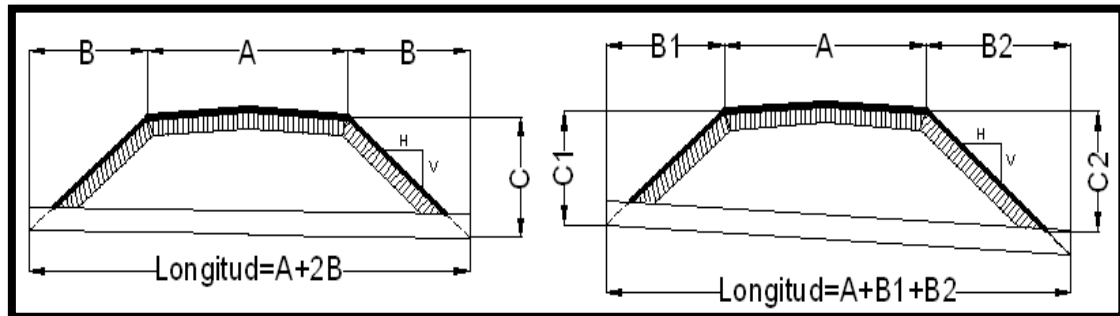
Longitud de alcantarillas (Fuente: MTOP, 2003).
